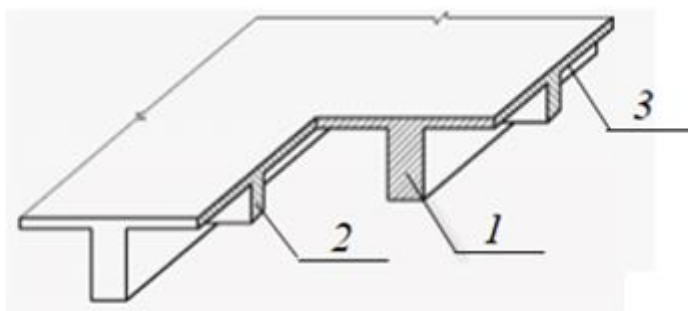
Фрагмент ребристого перекриття [28]: 1 — головна балки,
